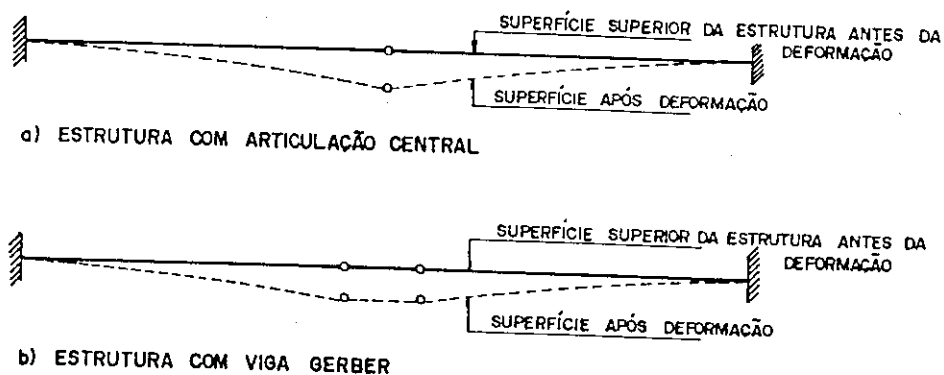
DEFORMAÇÃO DAS ESTRUTURAS COM ARTICULAÇÃO E VIGA GERBER
